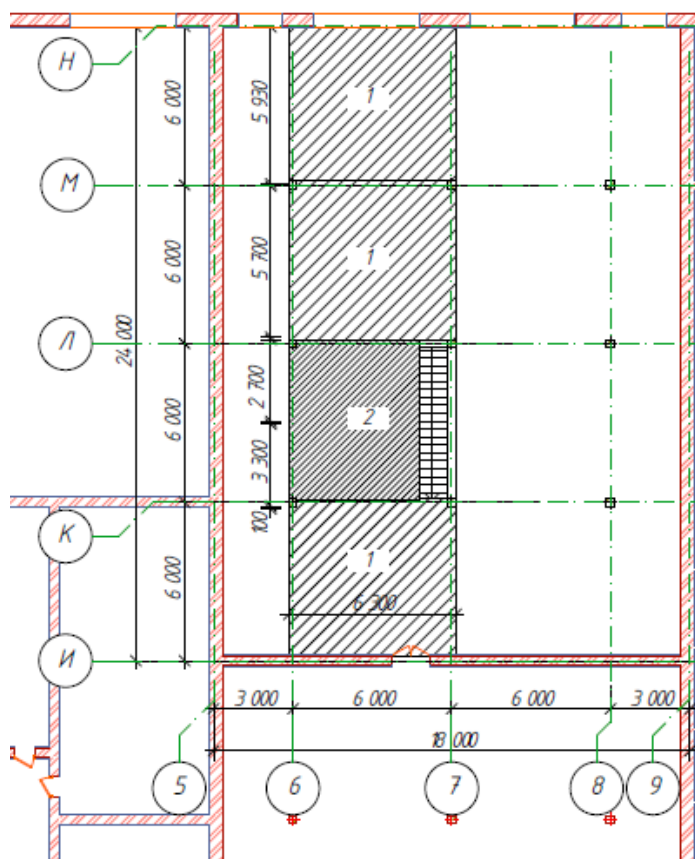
Виды площадок устраиваемого перекрытия
